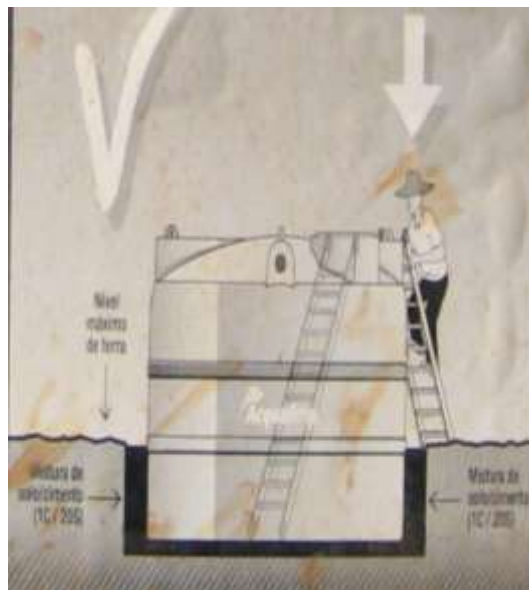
Demonstração da mistura solo/cimento (1c/20s).
